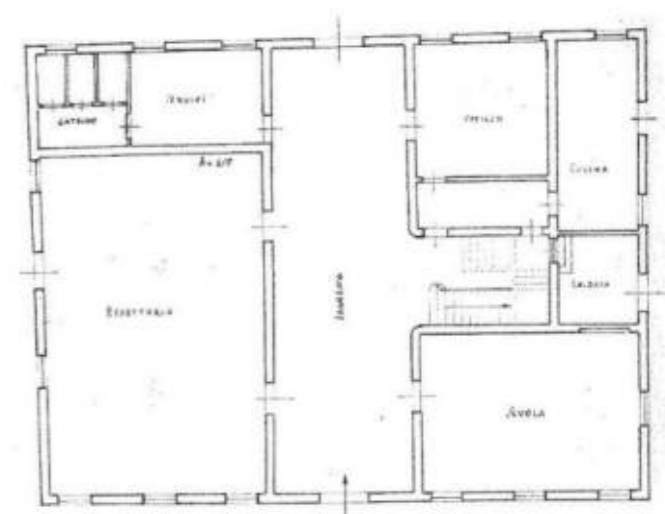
Fabbricato Principale. Planimetria Piano Terra
